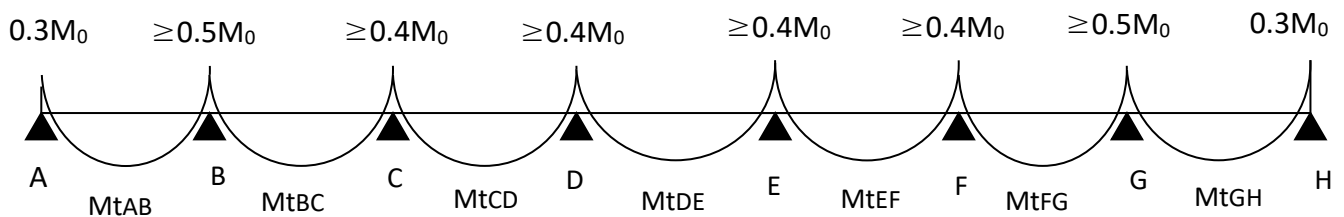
Schéma statique de la méthode forfaitaire d'une poutrelle a huit
